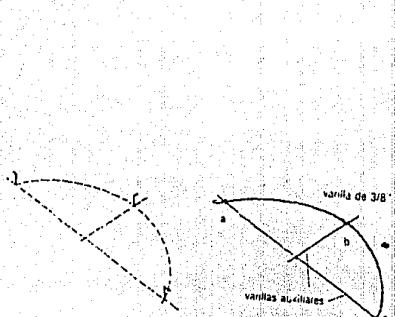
Trazado en el suelo de la geometría de las maestras (directrices). Doblando sobre el trazo de las varillas de 3/8", amarrando con varillas auxiliares los puntos a, b y c para que no se deforme la pieza.
